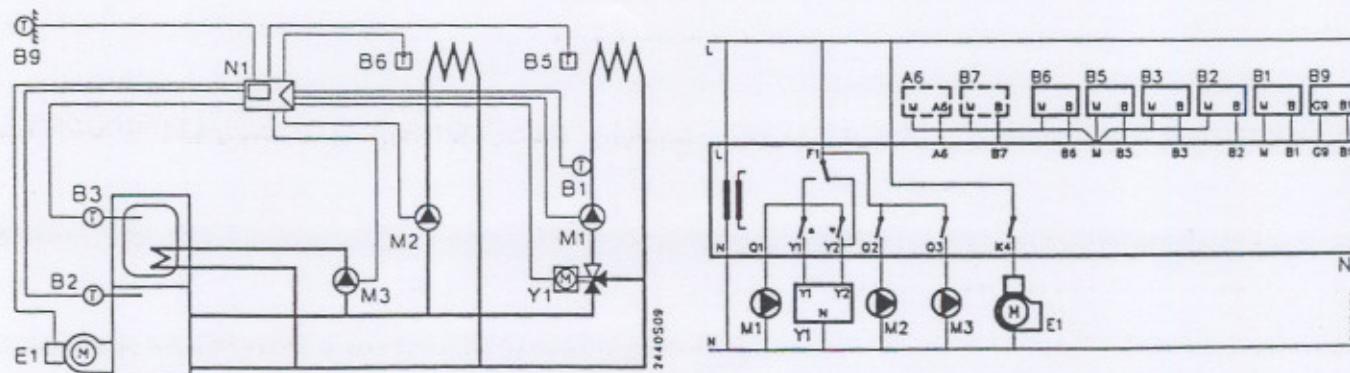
1-stupňový hořák, čerpadlový topný okruh a TUV s nabíjecím čerpadlem
